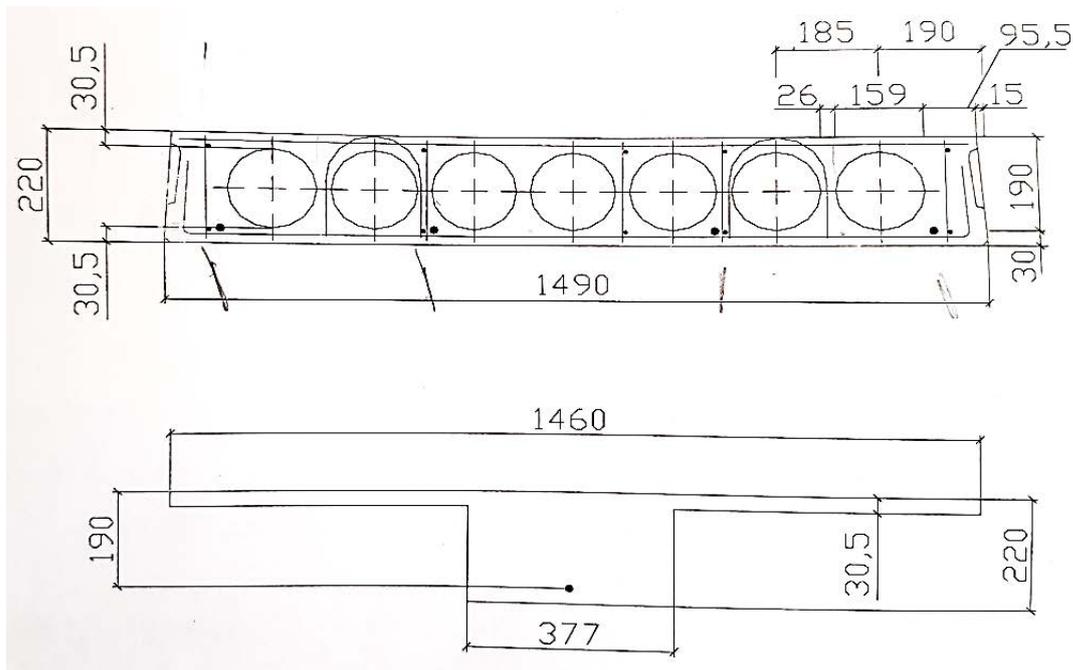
К расчету плиты перекрытия по предельным состояниям первой группы
